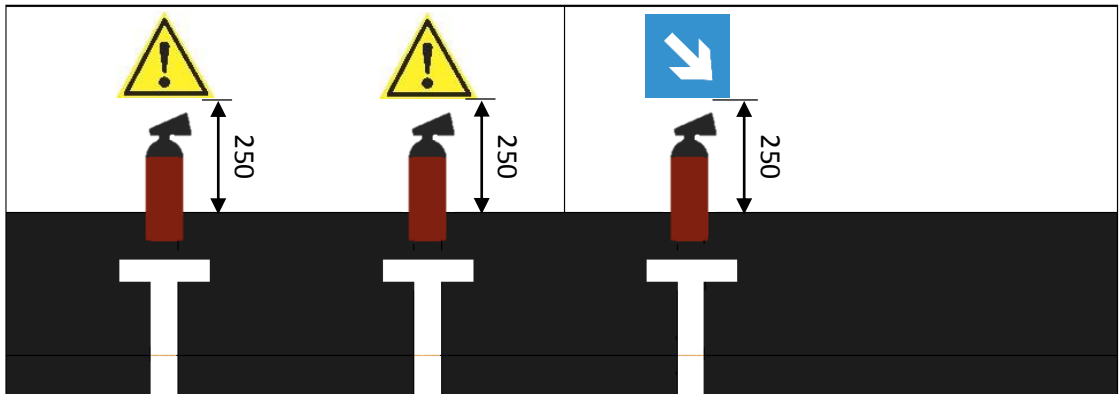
Чертёж парковки с огнетушителями и знаками
